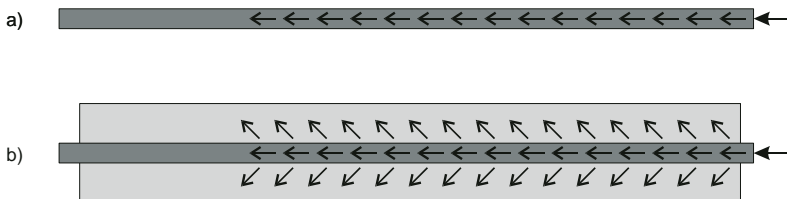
Geometria pręta stalowego osadzonego w betonie z zaznaczeniem punktów pomiarowych
